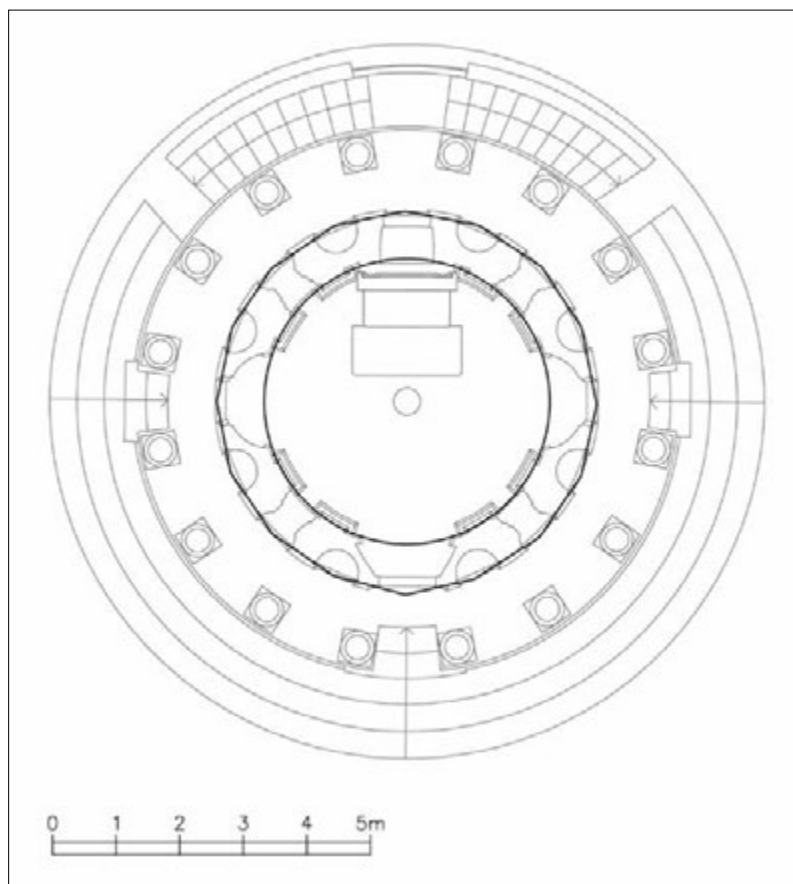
Tempietto di San Pietro in Montorio, il poligono a sedici lati e l'impianto circolare individuati rispettivamente dalle paraste esterne e interne (schema tracciato sulla base della pianta elaborata da M. Attenni e V. Caniglia)
